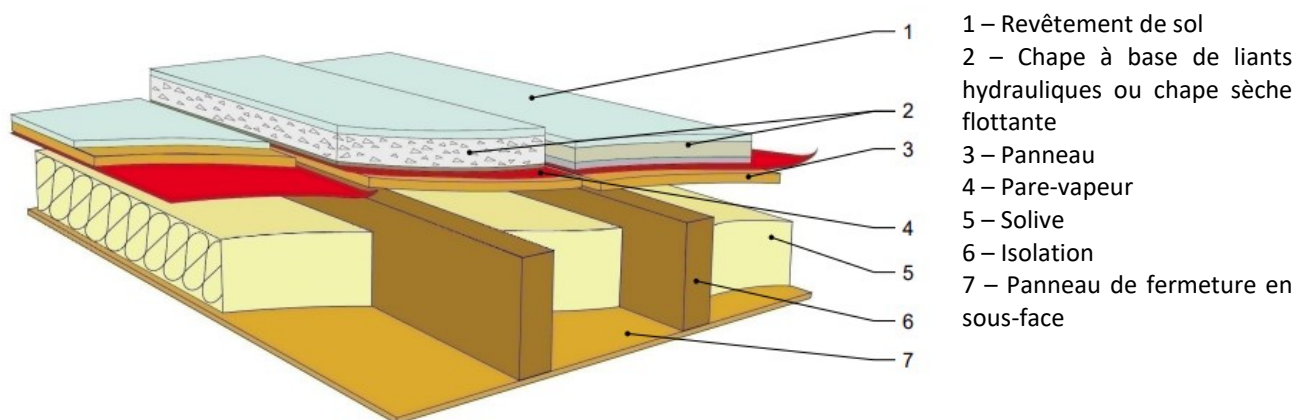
Plancher bas sur vide sanitaire par panneaux sur solivage bois avec sous-face continue
